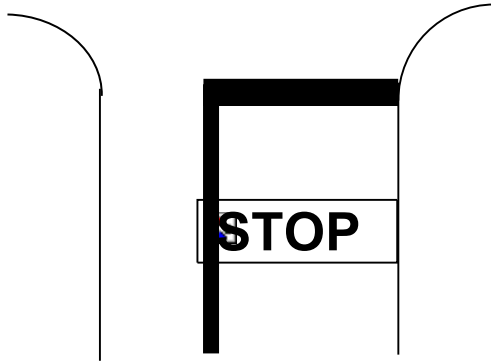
Schéma de signalisation stop sur chaussée.
